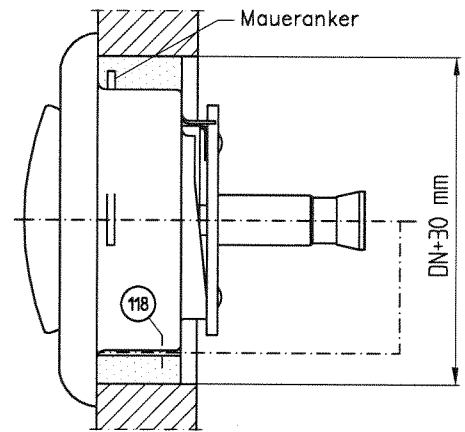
Einbaubeispiel mit Mörtel oder Beton
